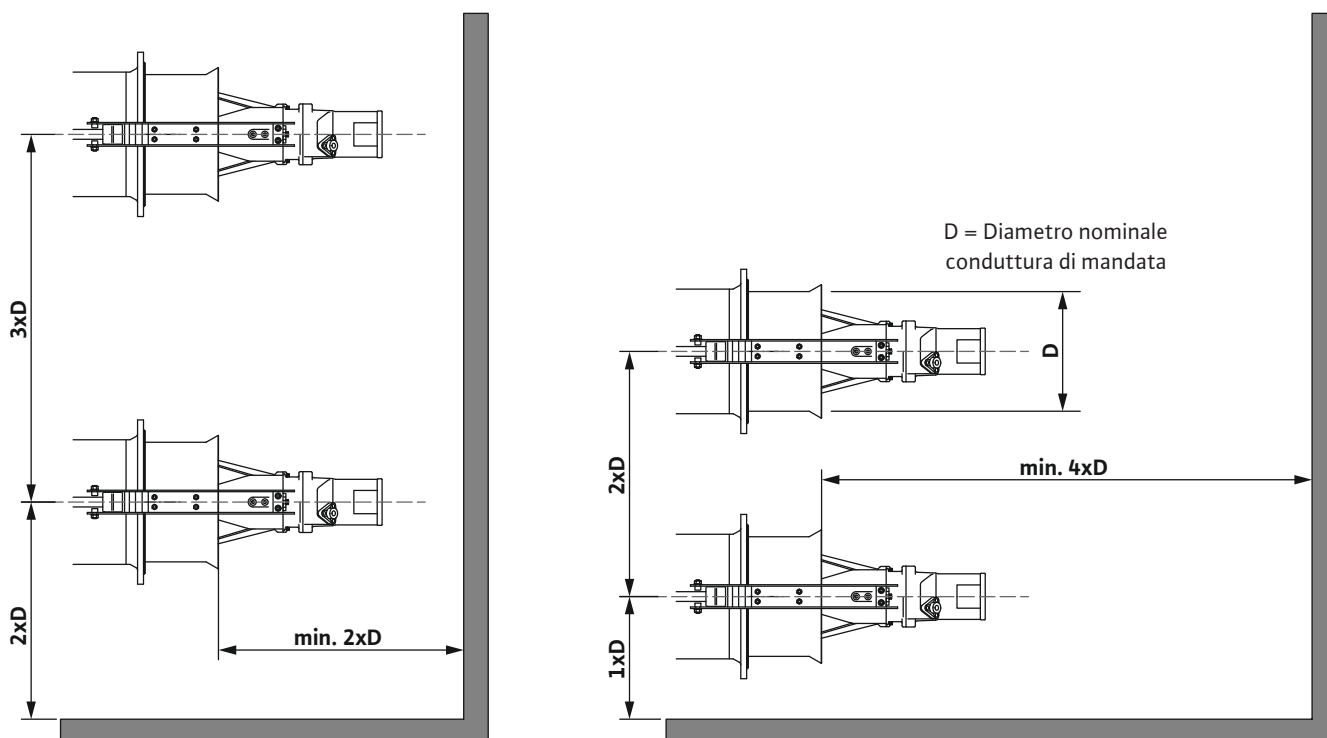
Distanze di sicurezza minime dalle pareti e dalle installazioni
